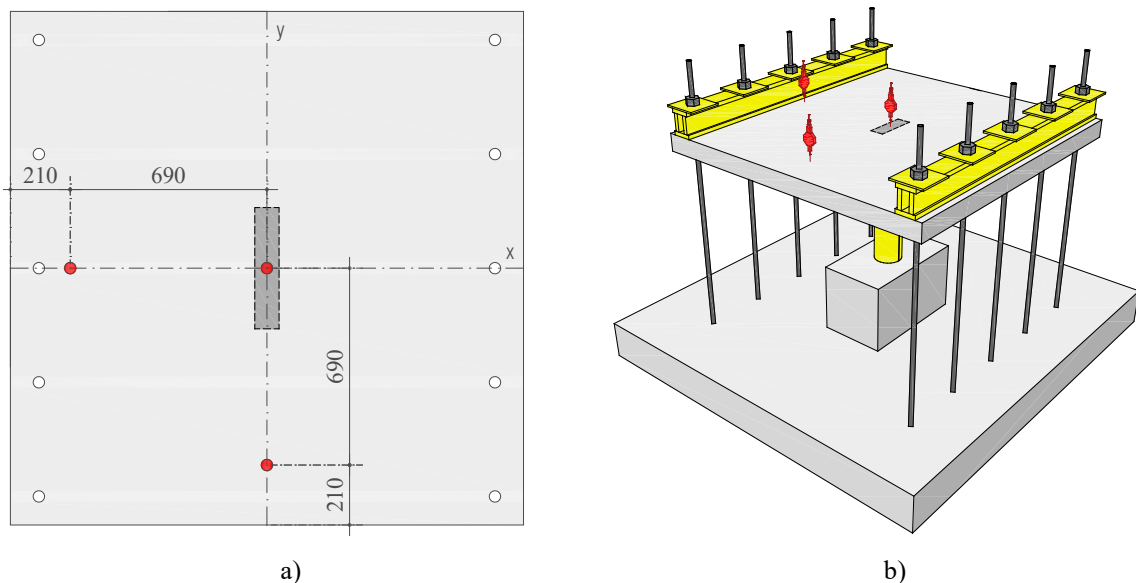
Posicionamento dos LVDT em planta (a) e em perspectiva (b) (mm)
